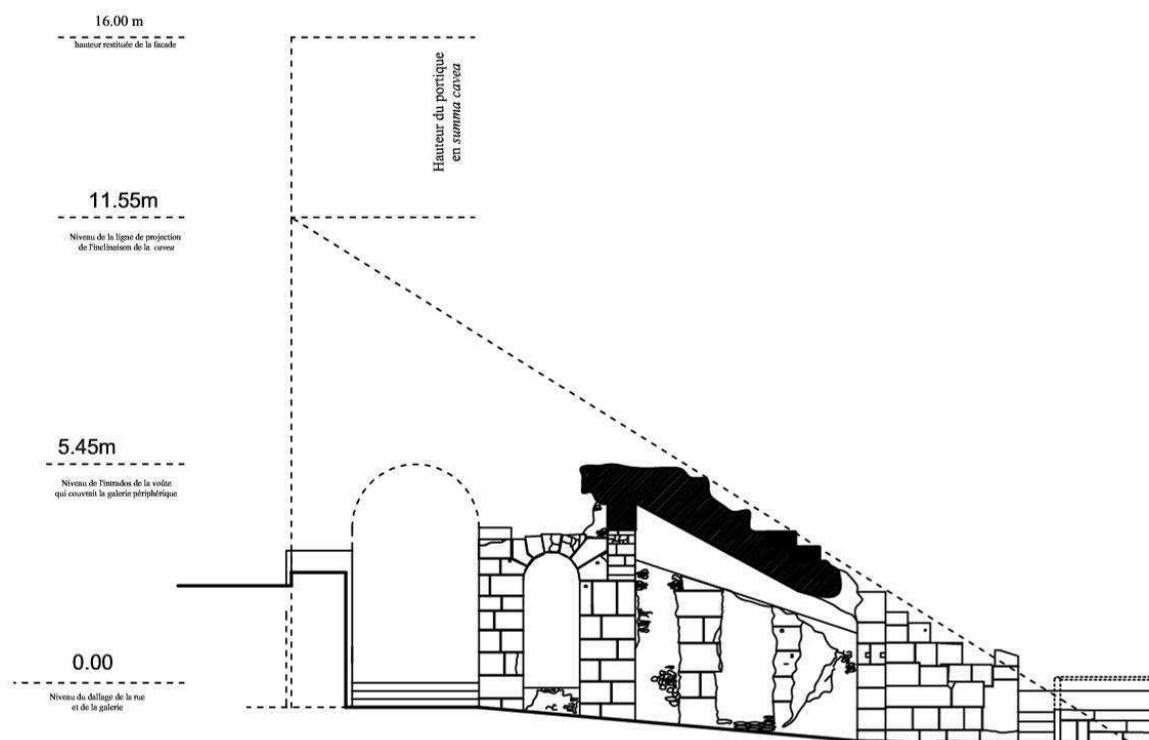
coupe sur l'*aditus maximus* ouest et restitution de la hauteur de la façade courbe.
